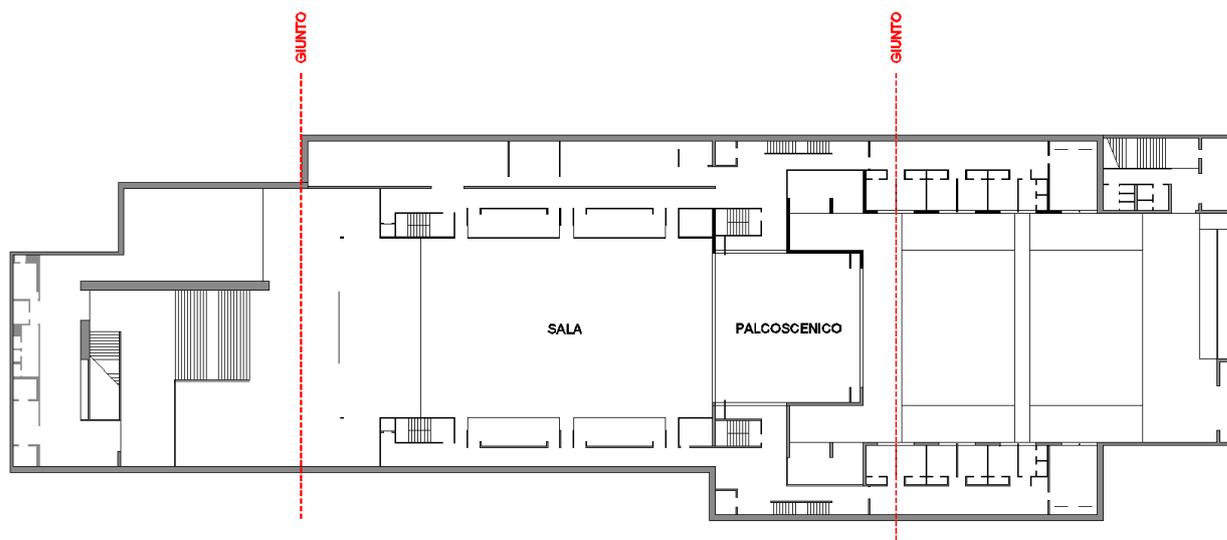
PLANIMETRIA SCHEMATICA DEL NUOVO TEATRO
